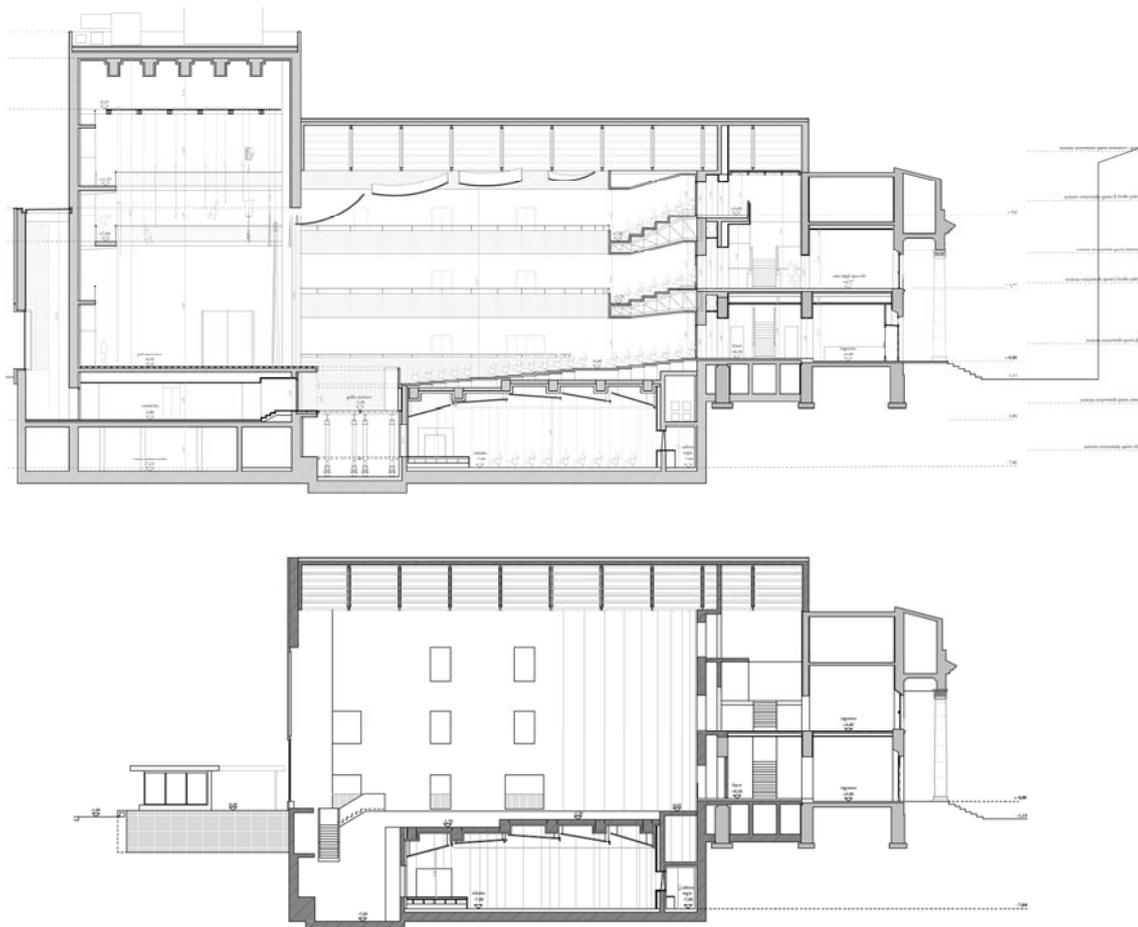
Progetto complessivo e progetto del primo stralcio funzionale, sezione longitudinale
